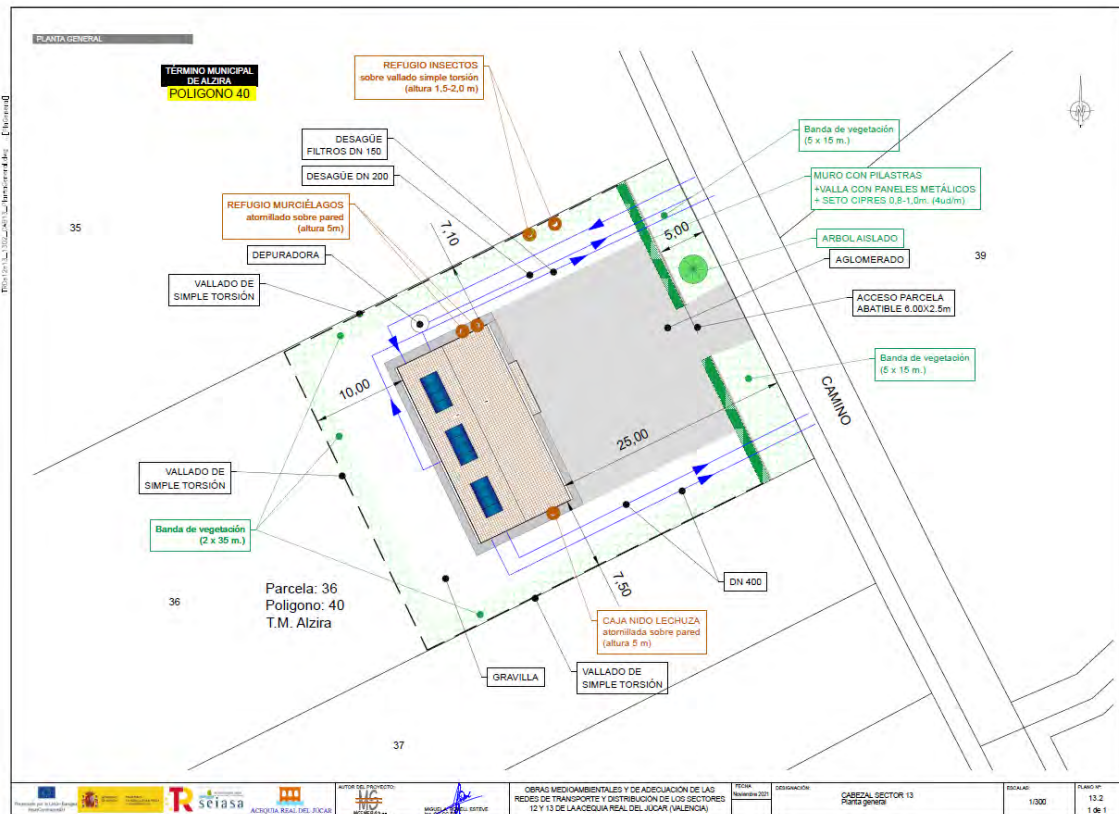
Plano nº 13.2: Cabezal sector 13. Planta general.
